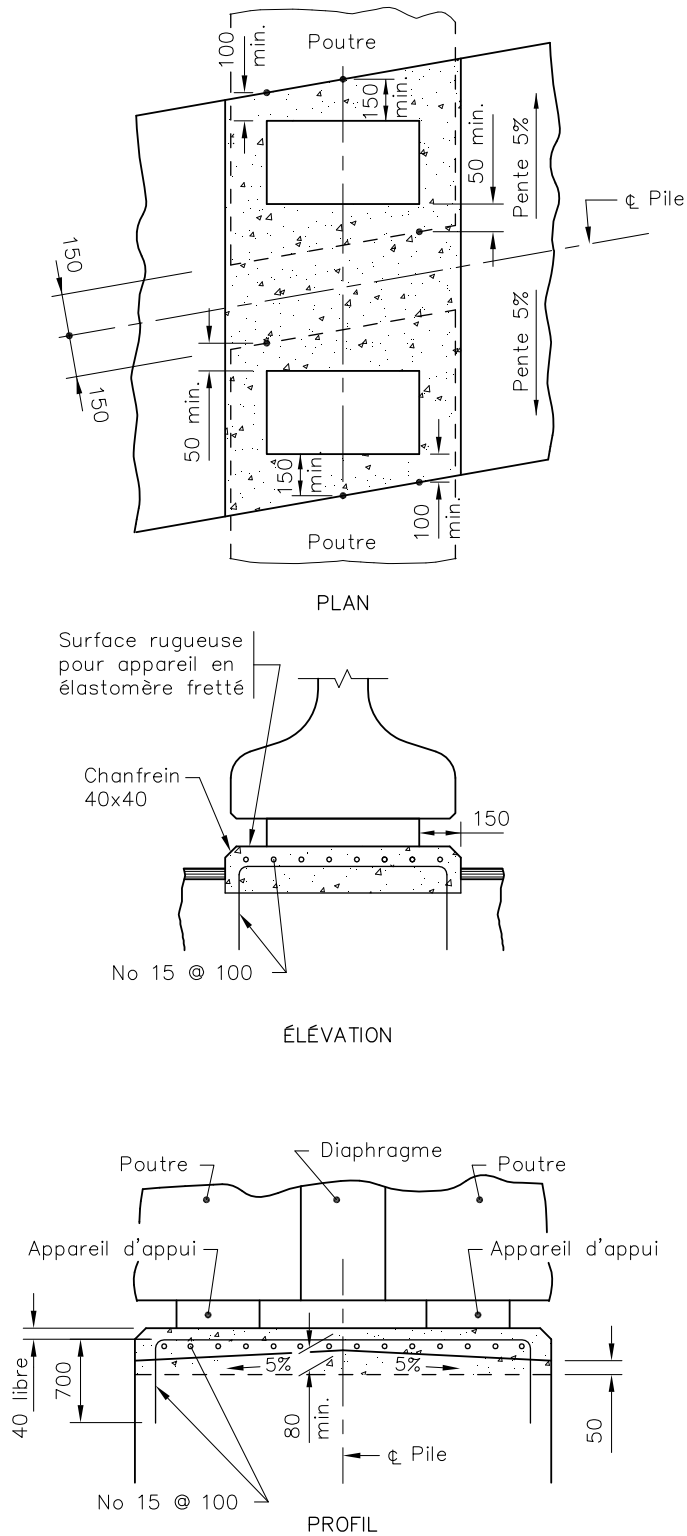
Bloc d'assise d'un appareil d'appui (à une pile)
